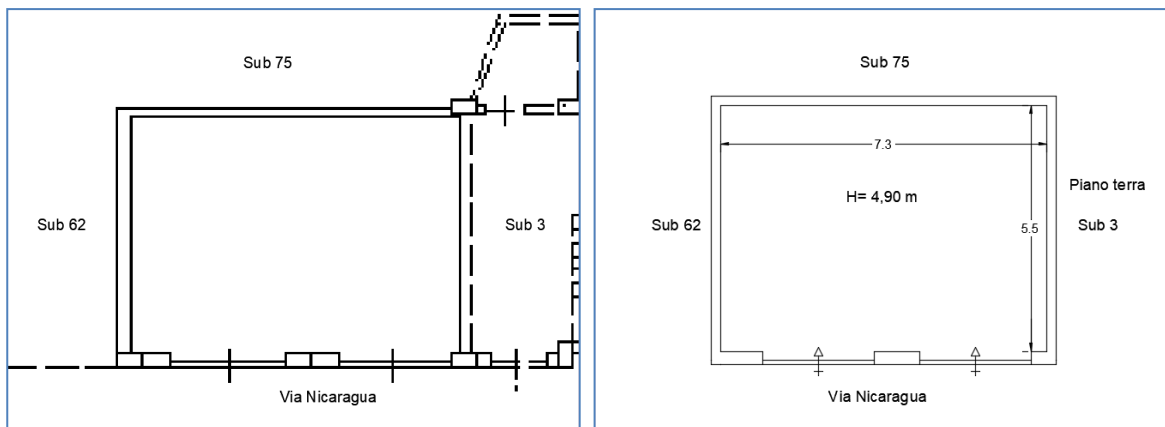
Confronto tra la Planimetria catastale (stralcio a sx) e restituzione grafica dello stato dei luoghi (a dx)
